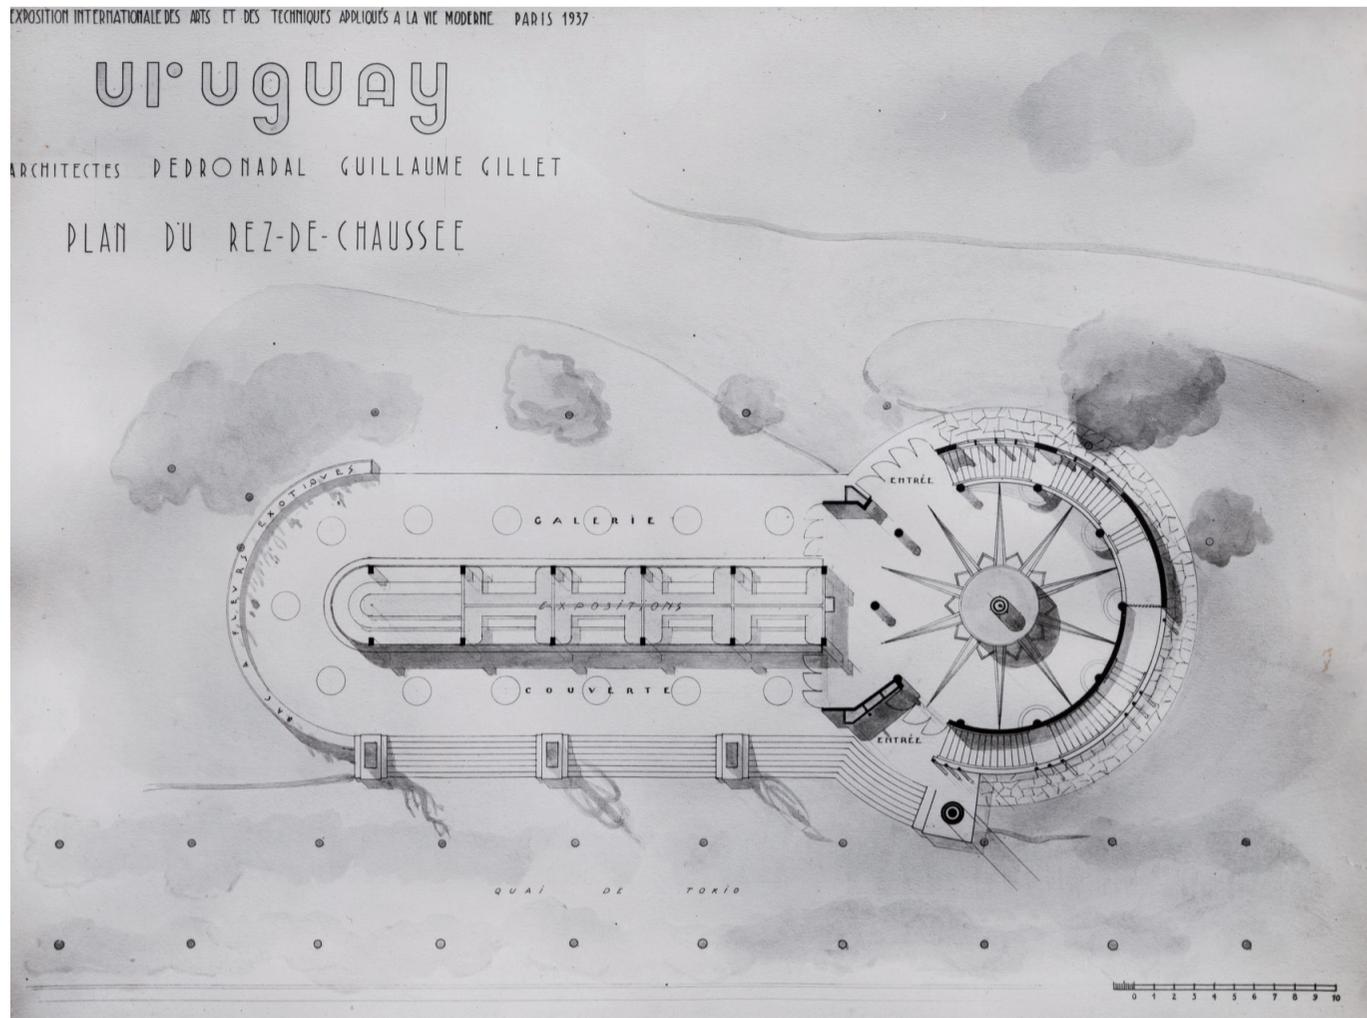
Plano de la planta baja del pabellón uruguayo en la Exposición de París, 1937.
